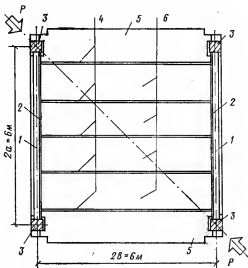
План испытанной на сдвиг ячейки перекрытия
